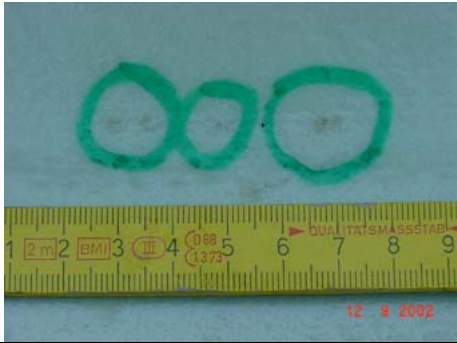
Prüfgeschiebe, Splitt (1-5 mm)
